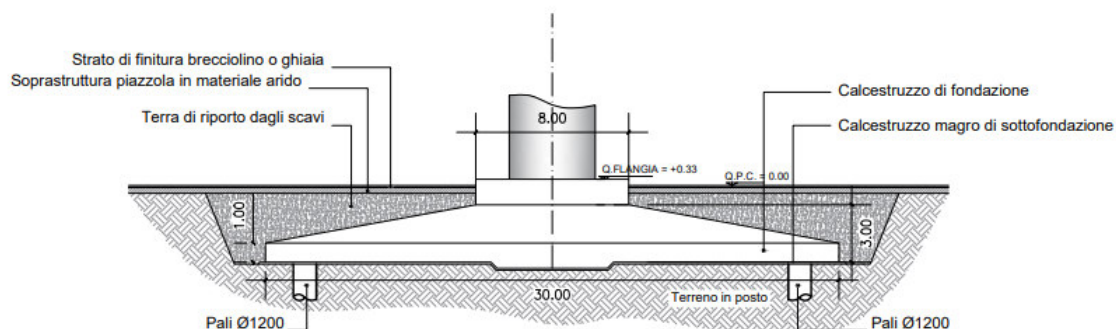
Pianta e sezione tipo fondazioni torre tipologia V162
